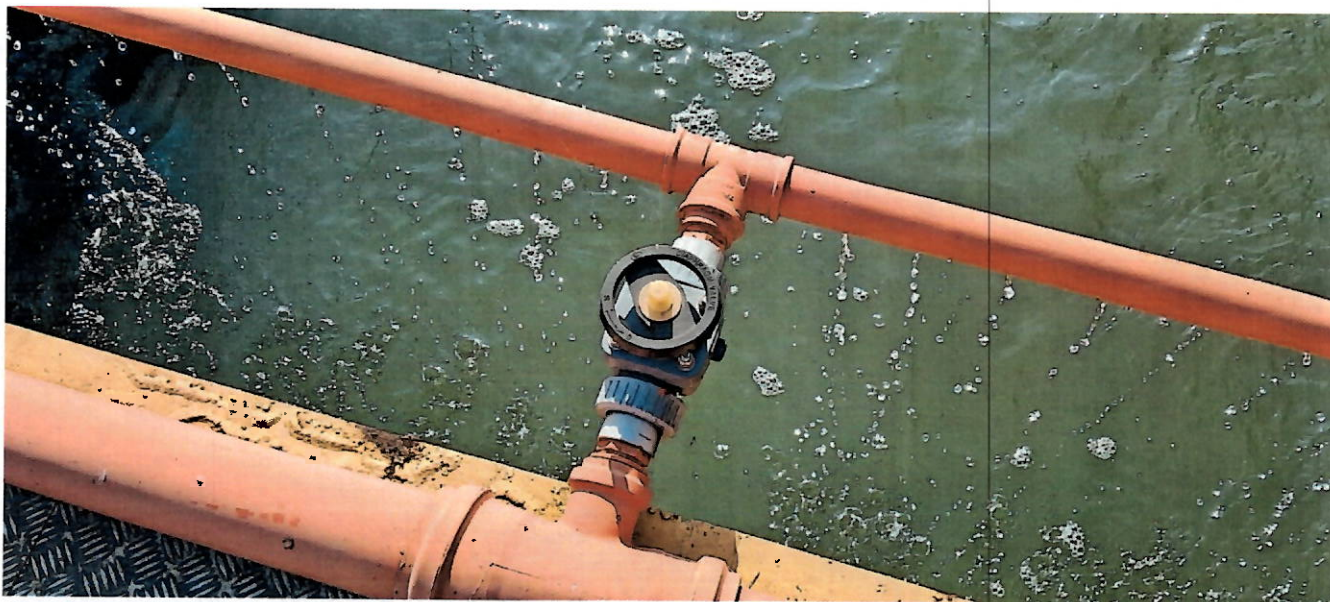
Ponto de aplicação de coagulantes controlado por válvula de diafragma.
